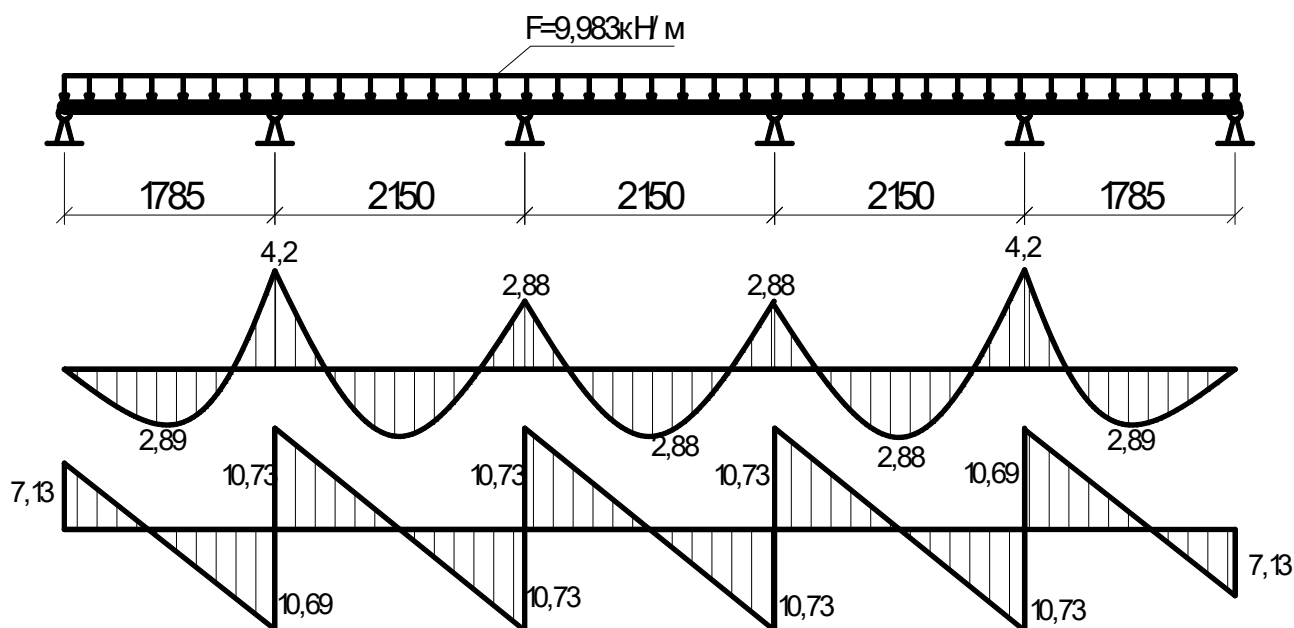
Расчетная схема монолитной плиты с эпюрами усилий
